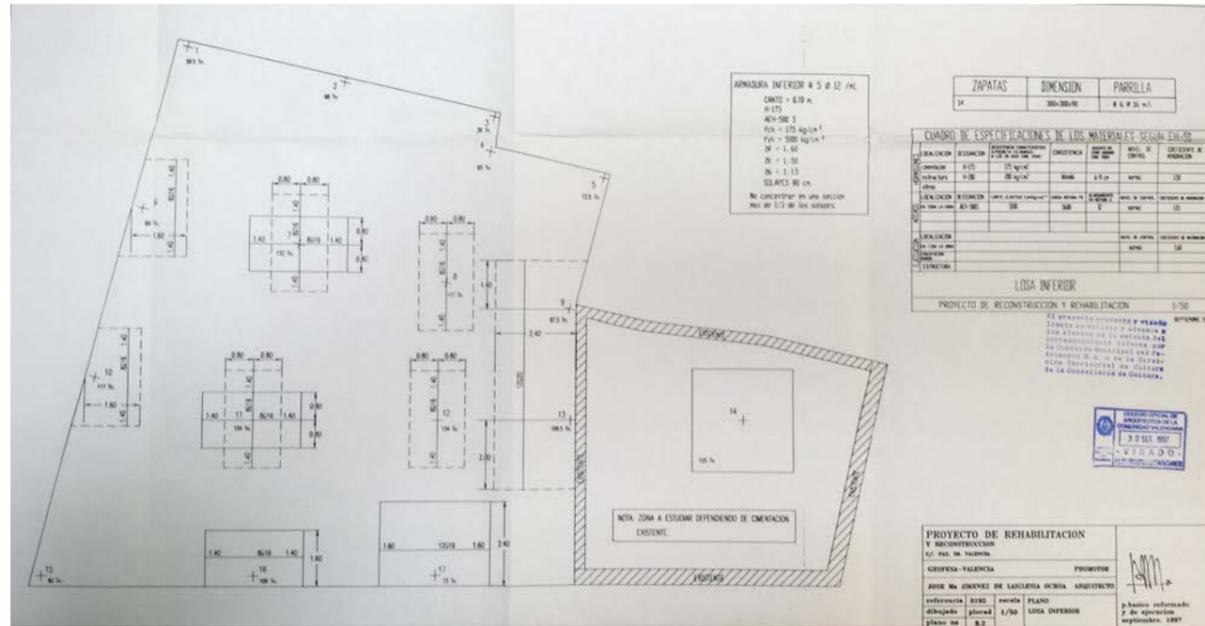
Losa de cimentación. Armadura inferior 5 Ø 12 / ml
